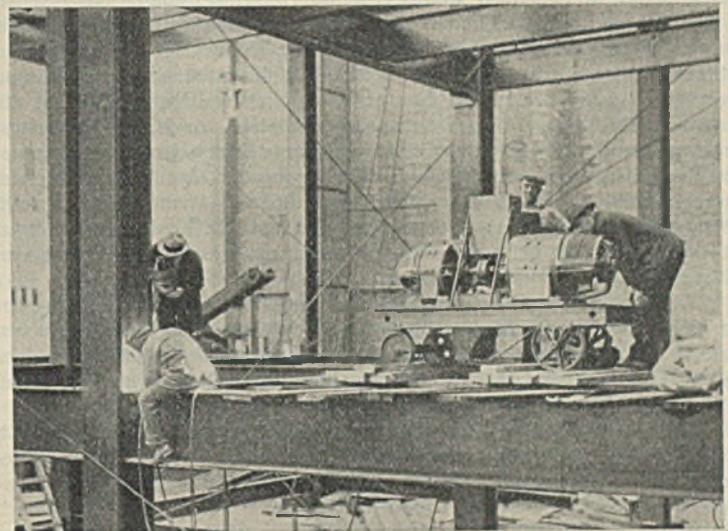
Ein schwerer Unterzug wird an den Steg der breit flanschigen I-Säule angeschweißt.
